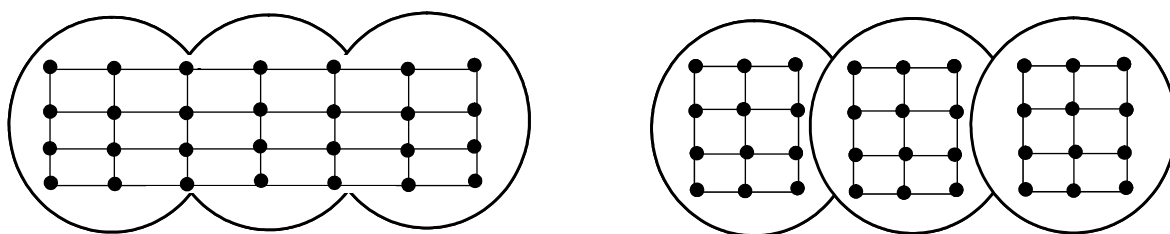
Vista in pianta di un diaframma di pali secanti in terreni stabili a sinistra ed in terreni instabili a destra; i reticoli rappresentano l'armatura del diaframma -
